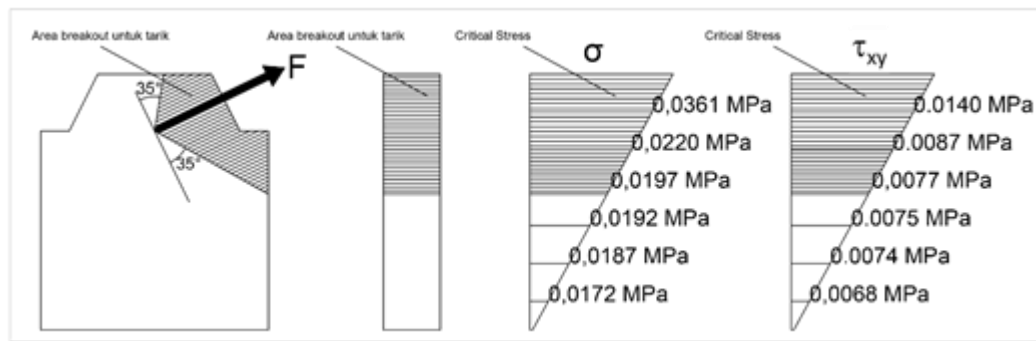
Ilustrasi jebol beton pada blok angkur
